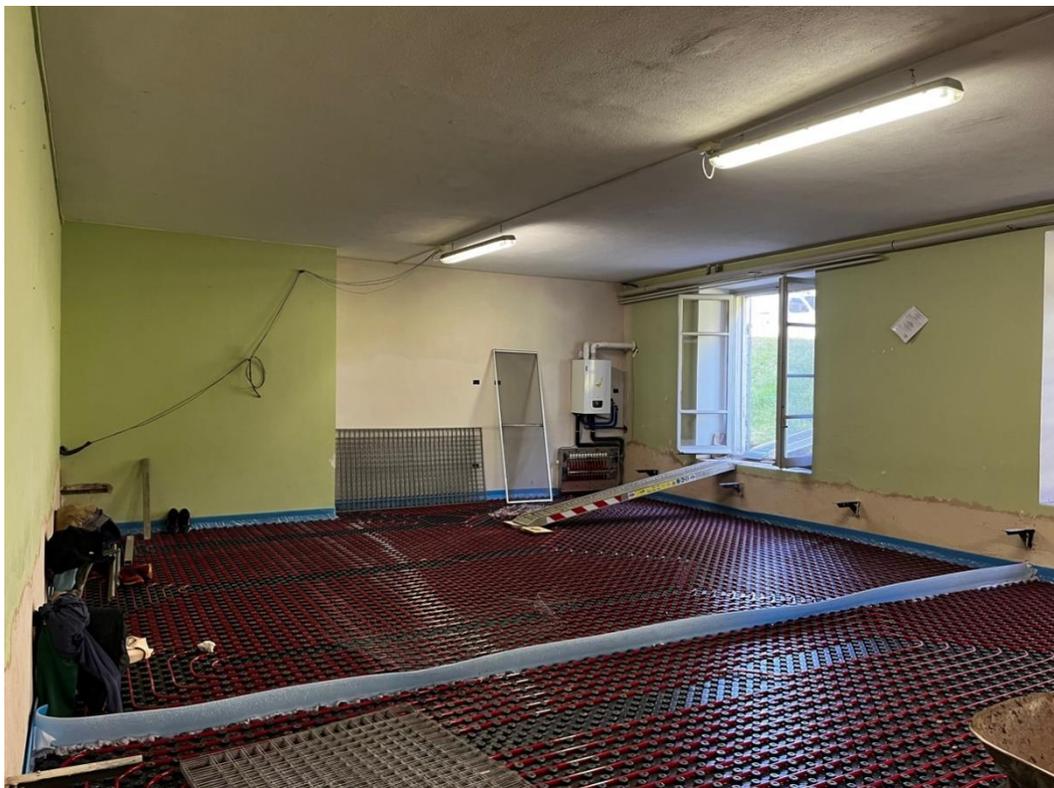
Vista dell'impianto di riscaldamento a pavimento posato
